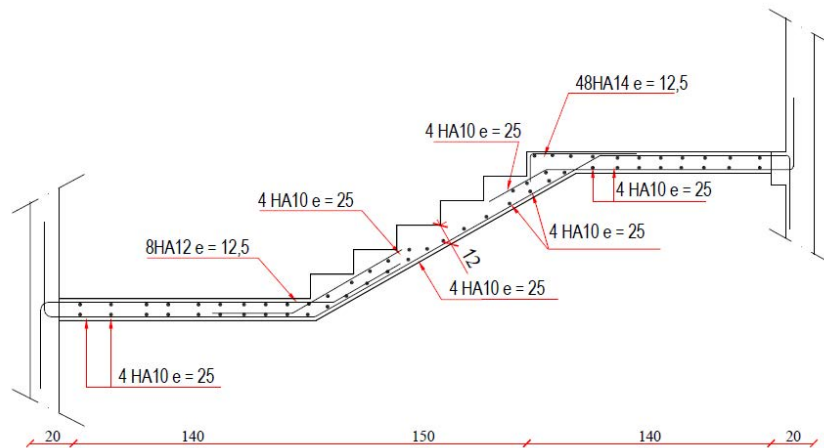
Ferrailage du volée 2 de l'escalier du RDC
